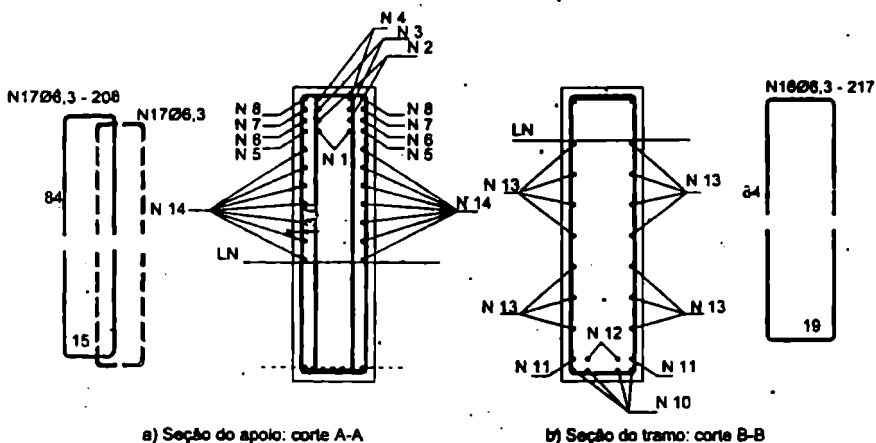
Detalhe da armadura nas seções transversais (medidas em cm).
